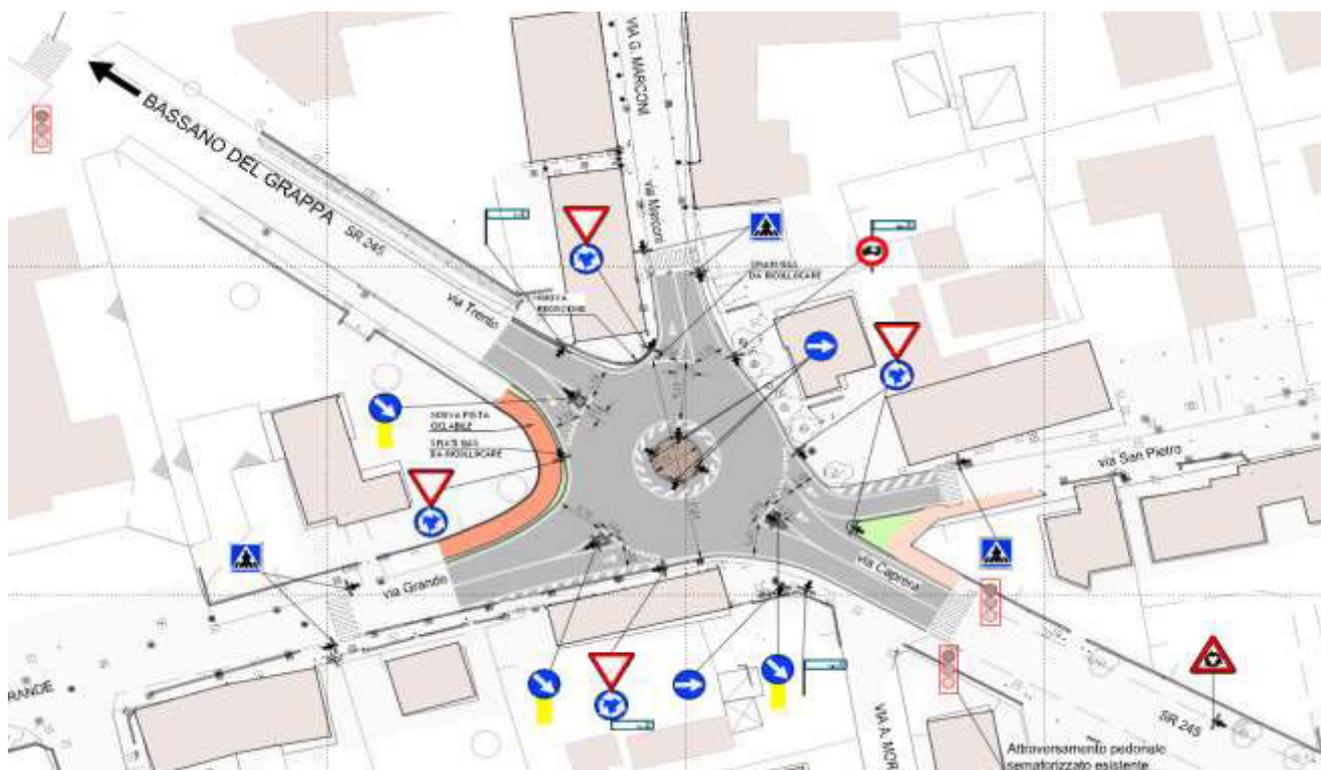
Planimetria di progetto con indicazione della nuova segnaletica.
